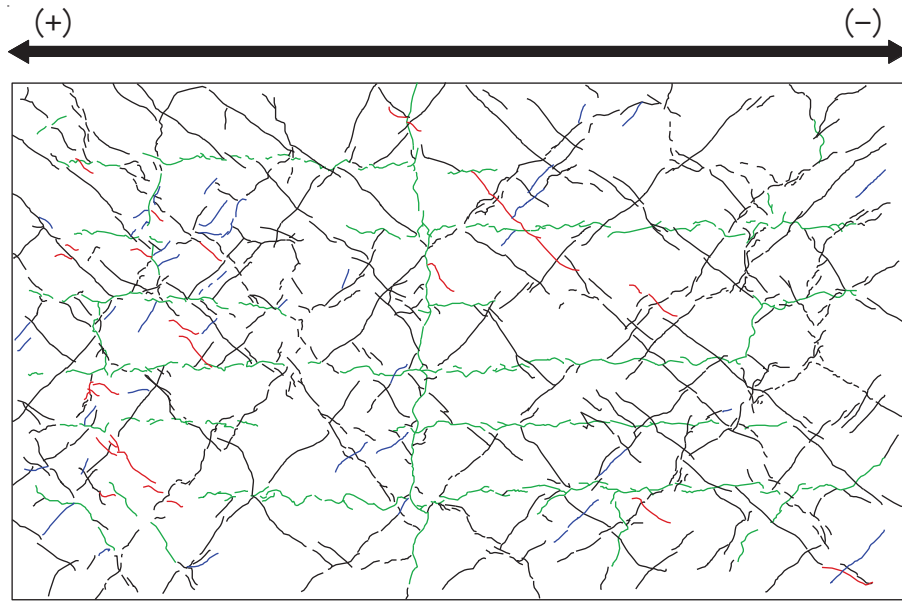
(11) 乾燥試験体 [1] $1/250\text{rad.}$ におけるひび割れ図
